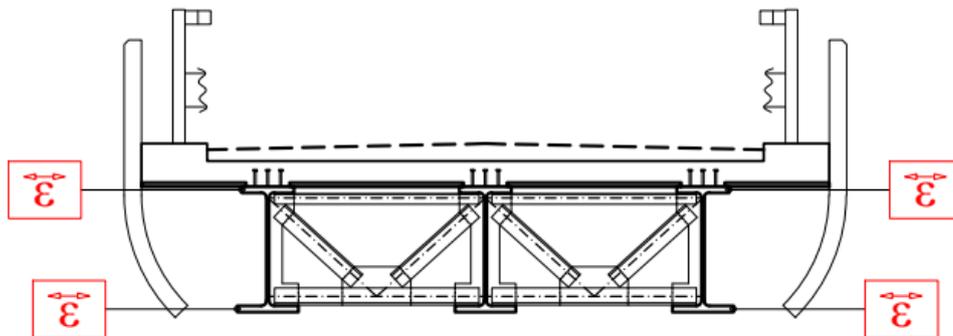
Ubicazione sensori su impalcato sezione a 3 travi (sezione trasversale viadotto Rampa Uscita SS75)
